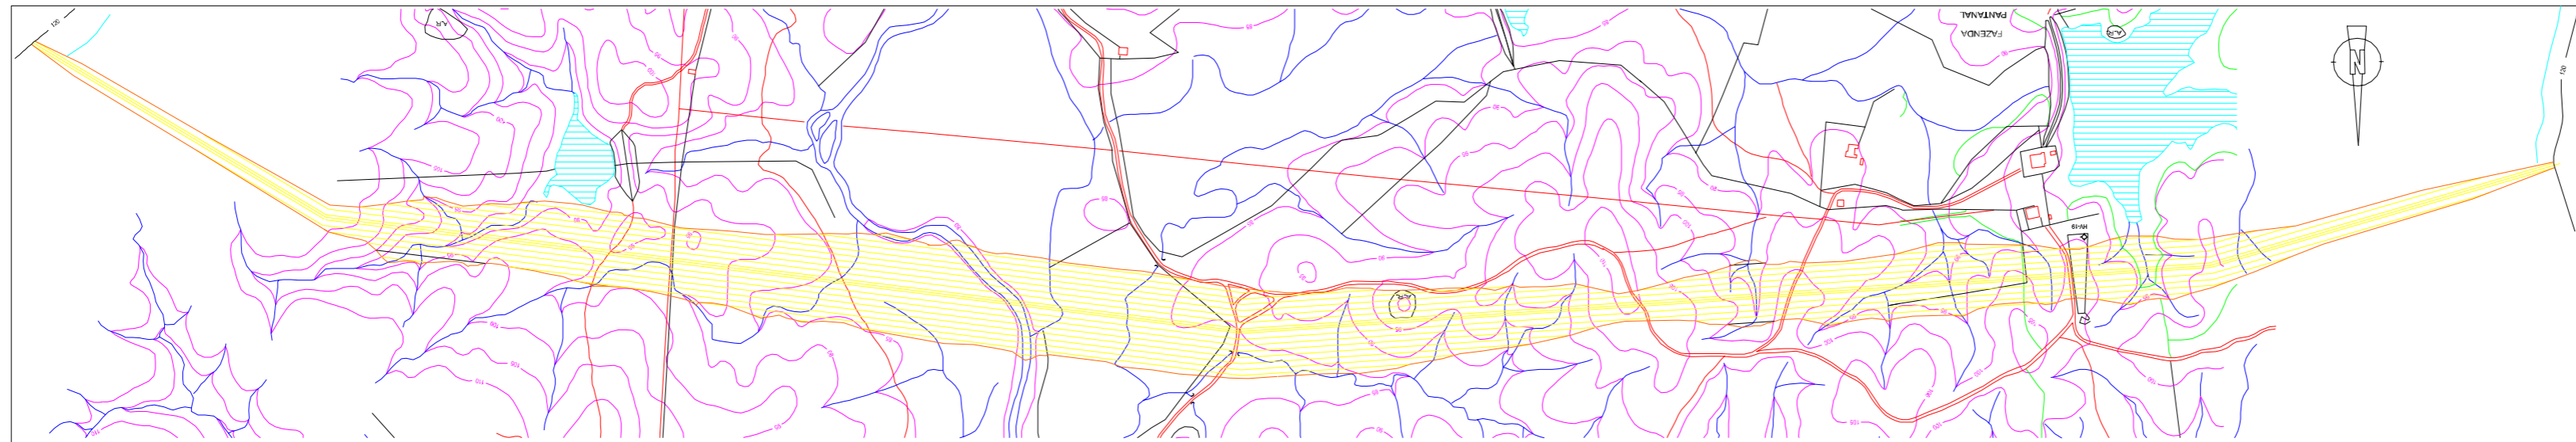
EIXO III - PLANTAS E PERFIL LONGITUDINAL
